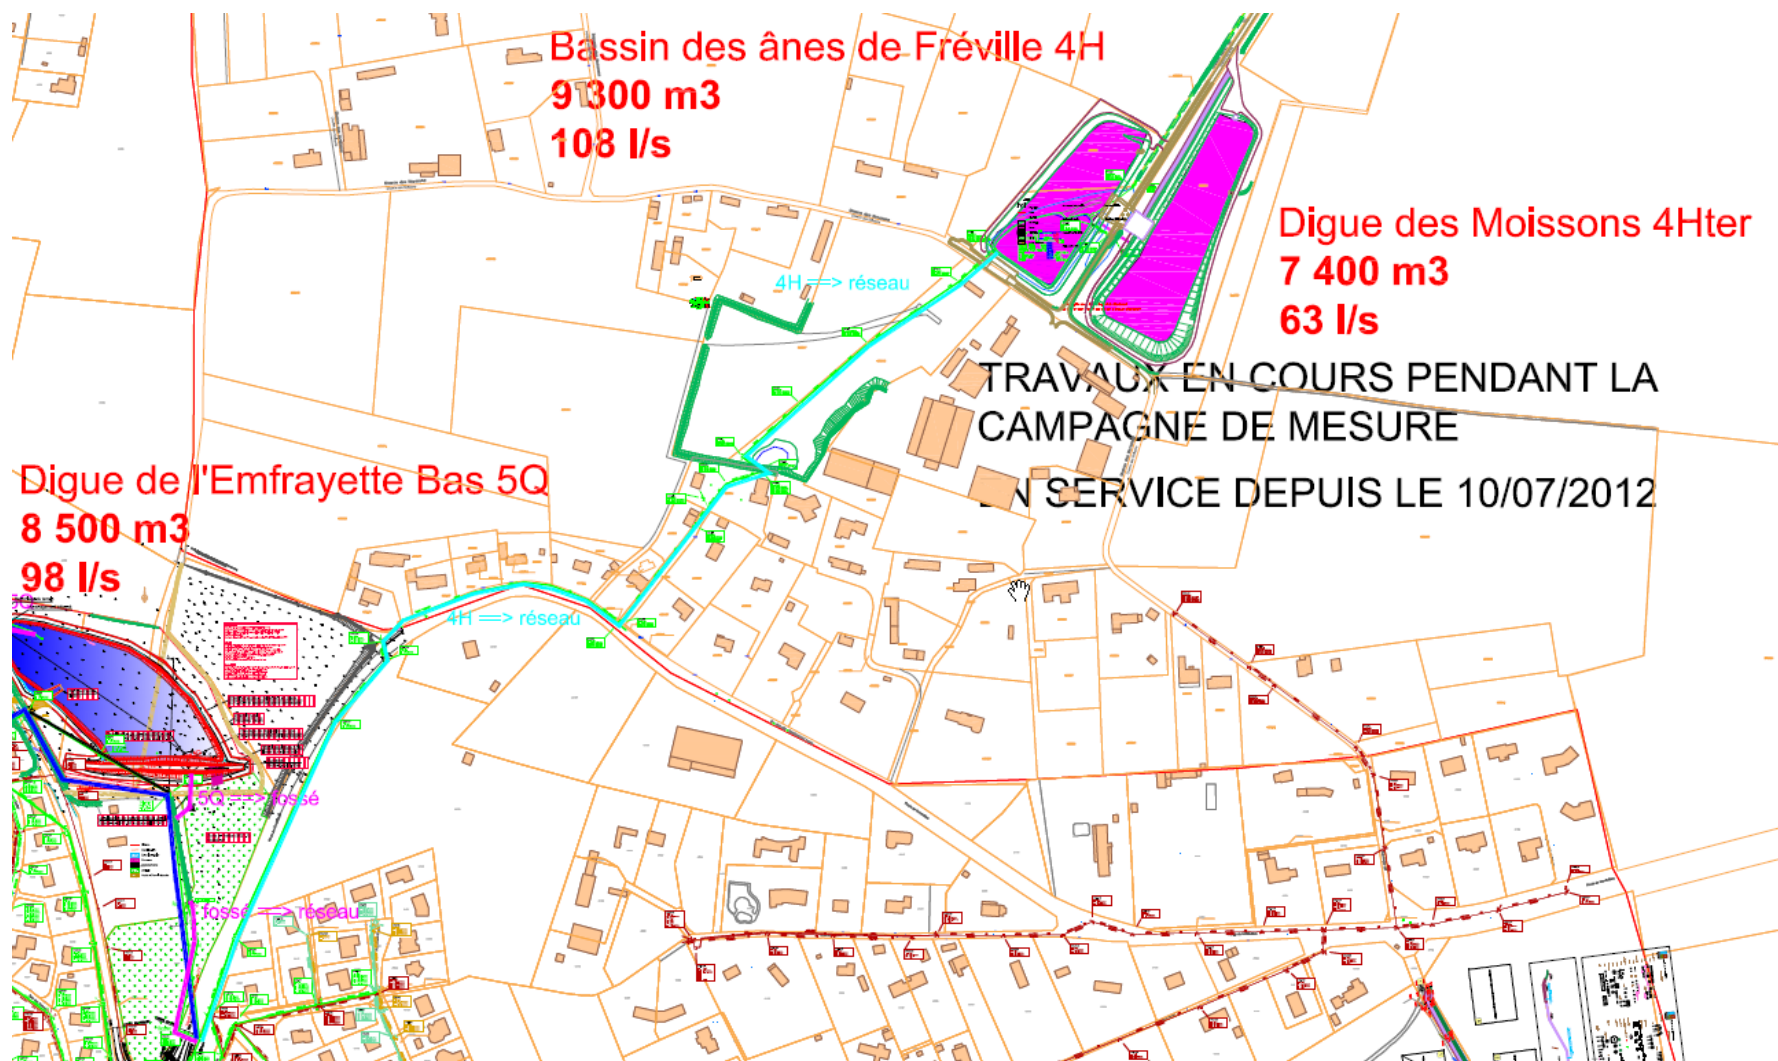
Enchaînement hydraulique – Ouvrages 4H et 4Hter
